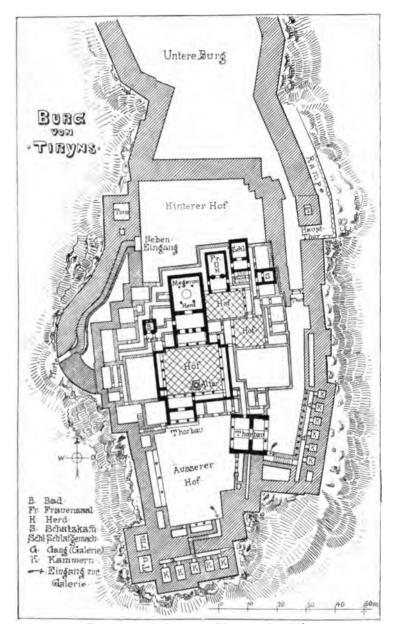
(3). Palast von Tiryns Grundriss.
